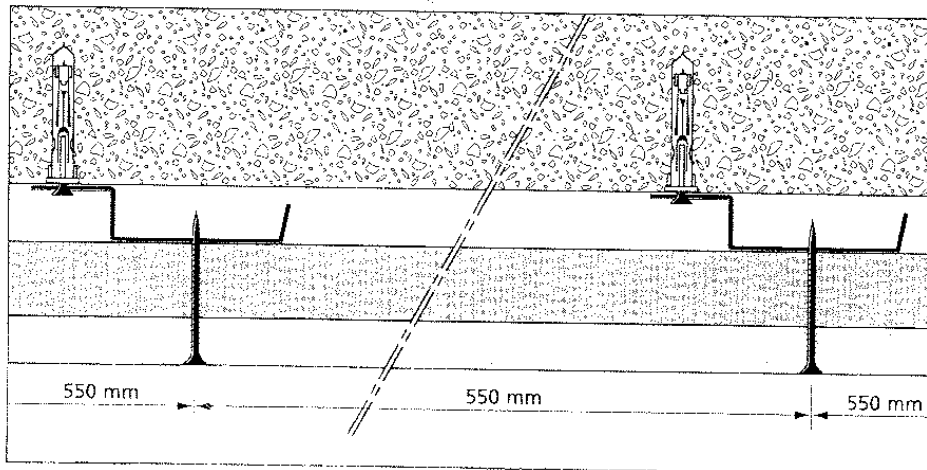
Ouvrages horizontaux ou inclinés – section verticale sur profilés en partie courante
